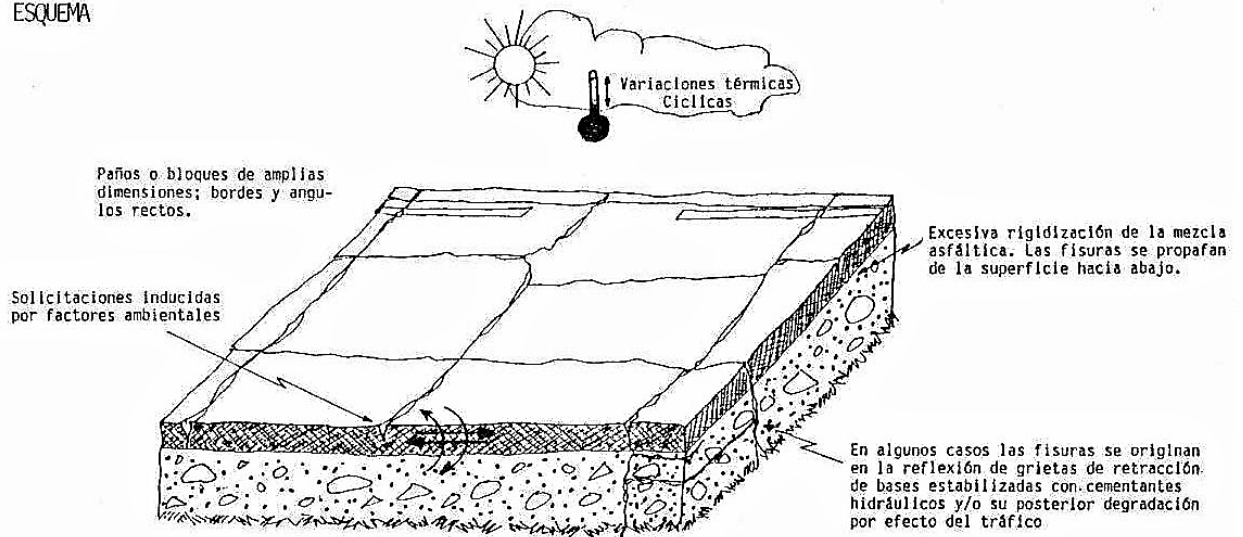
Esquema de fisura en bloque.⁶²
